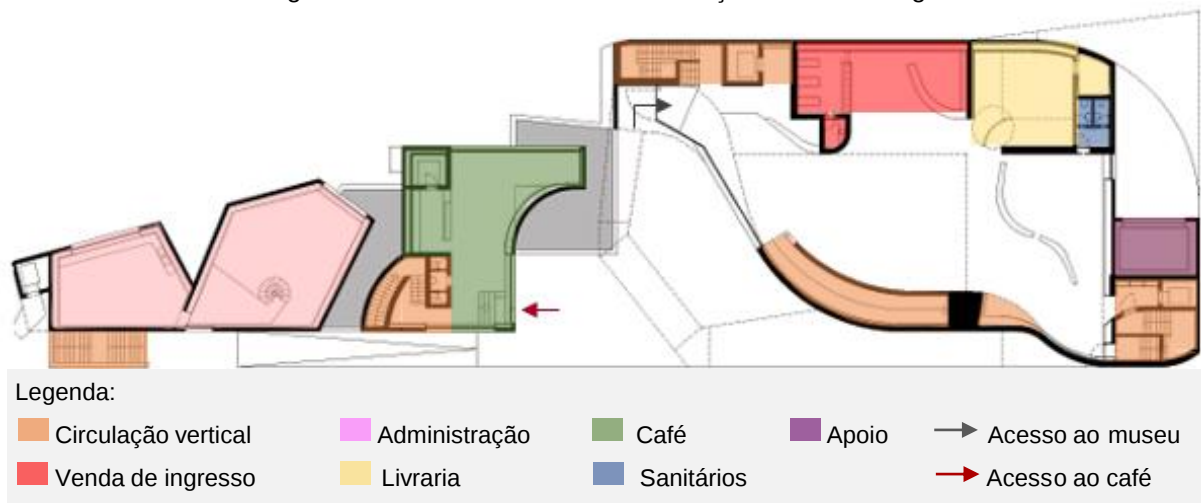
Planta do subsolo da Fundação Iberê Camargo
